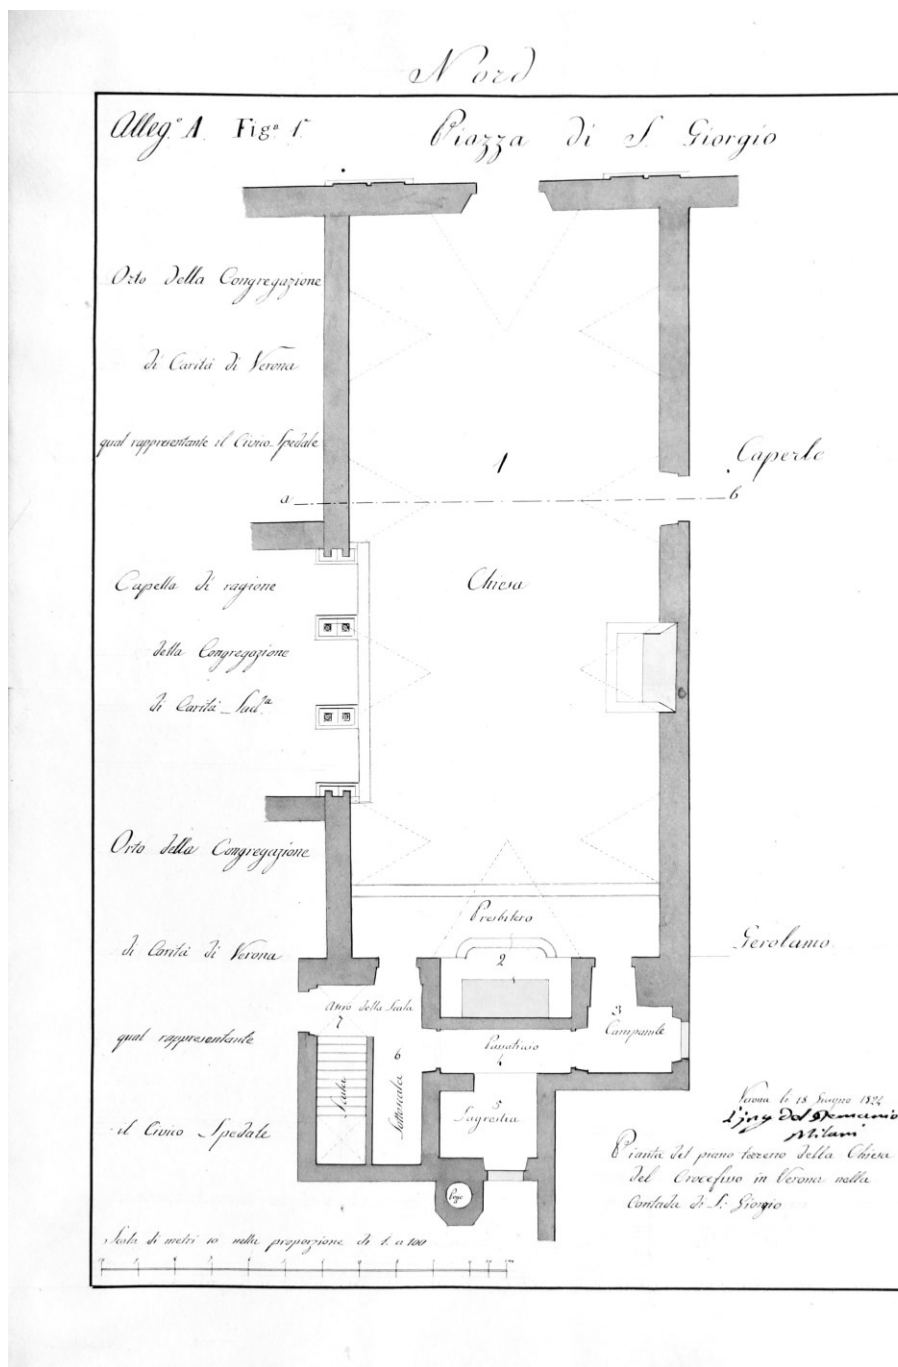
Planimetria del piano terreno dell'edificio con la chiesa del Crocifisso rilevata nel 1824 [Archivio di Stato di Verona, Delegazione provinciale, b. 786].
